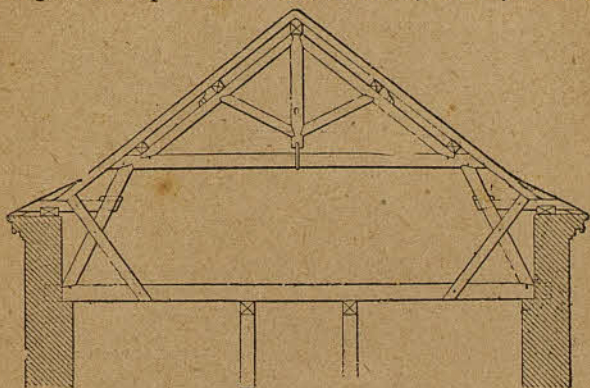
Armadura para una casa de 9 metros de ancho.
